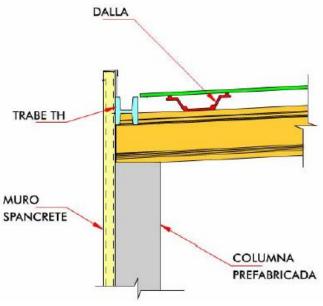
Configuración de montaje en sistema industrial con sistema prefabricado.
